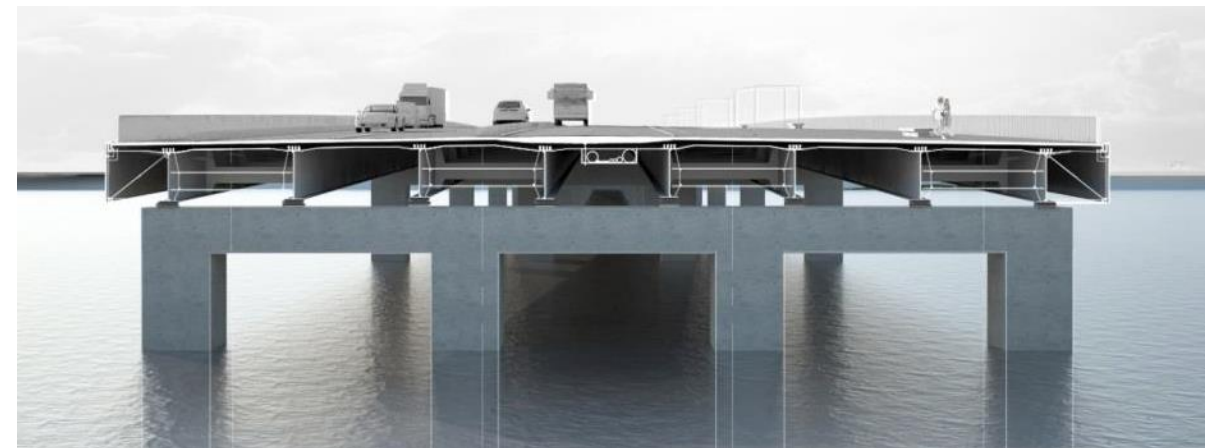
Représentation 3D de la structure métallique de l'ouvrage
